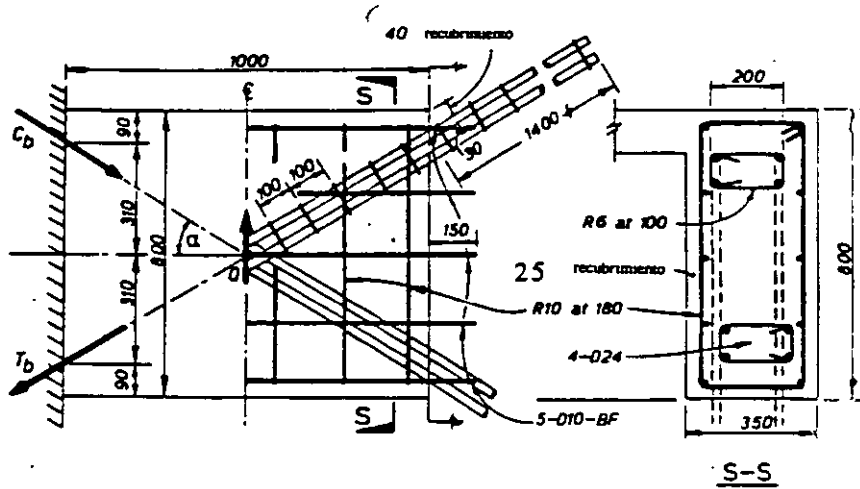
Detalles del refuerzo de una viga de acoplamiento
